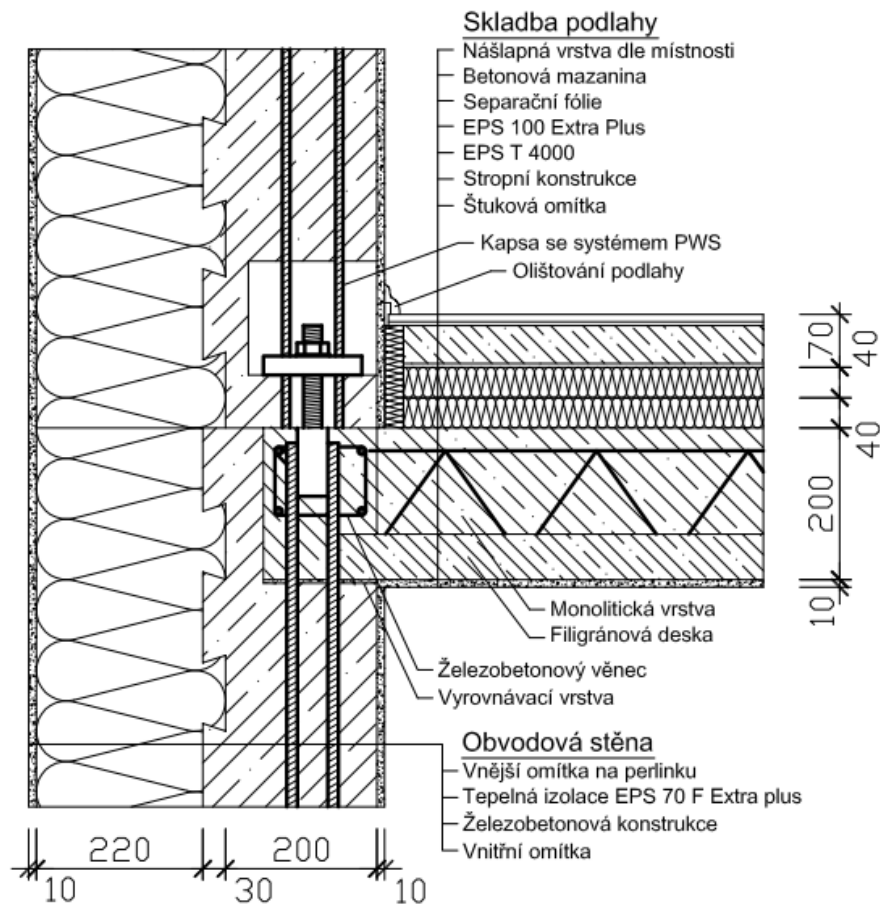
Detail spojení rovných sendvičových panelů 1:5 (autor práce)
